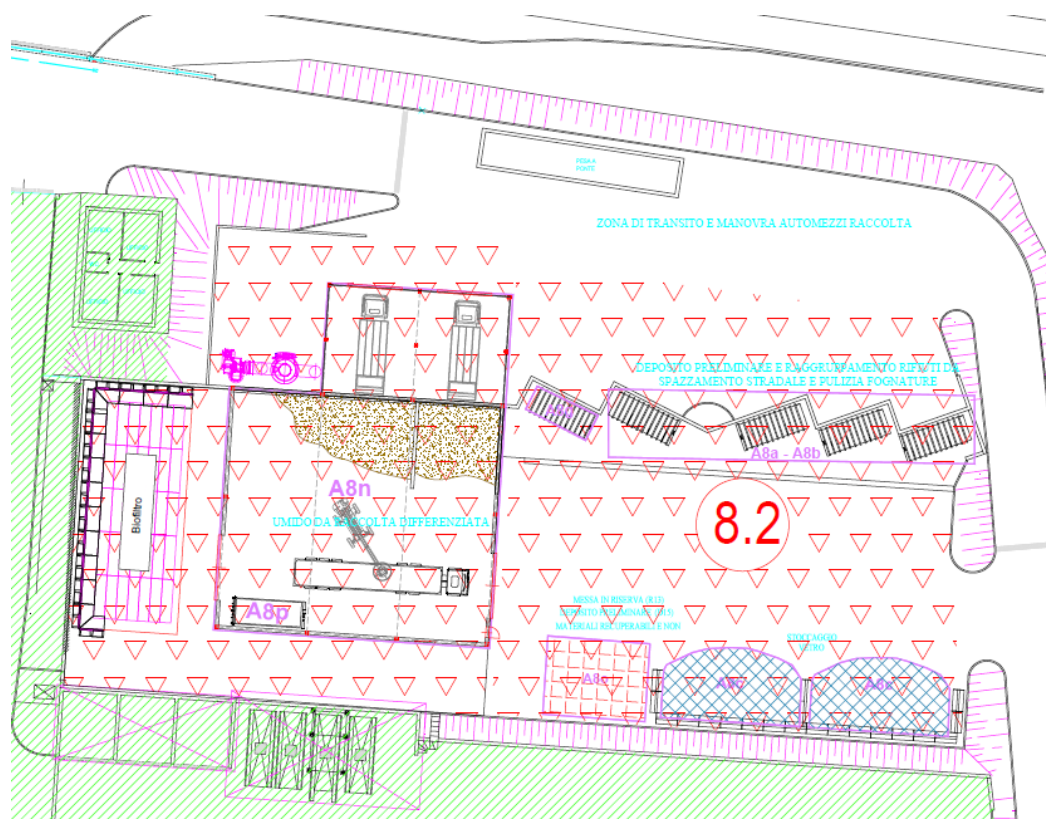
Estratto dell'Area 8.2 e dell'Area A8n da Tavola V “Planimetria generale dell'impianto (materia utilizzate e rifiuti prodotti) – Stato di progetto”
